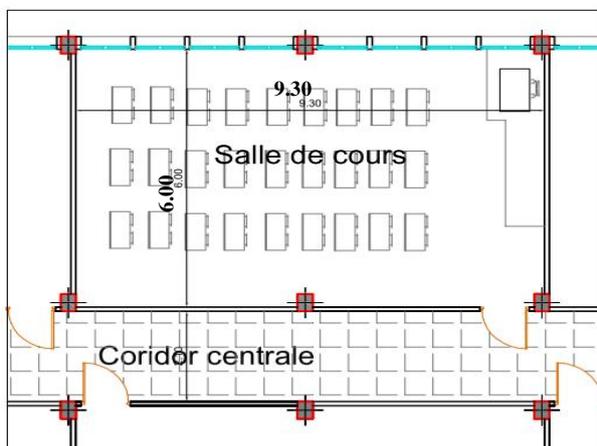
dimensions et aménagement d'une salle de classe du CEM Babouche Saïd.
